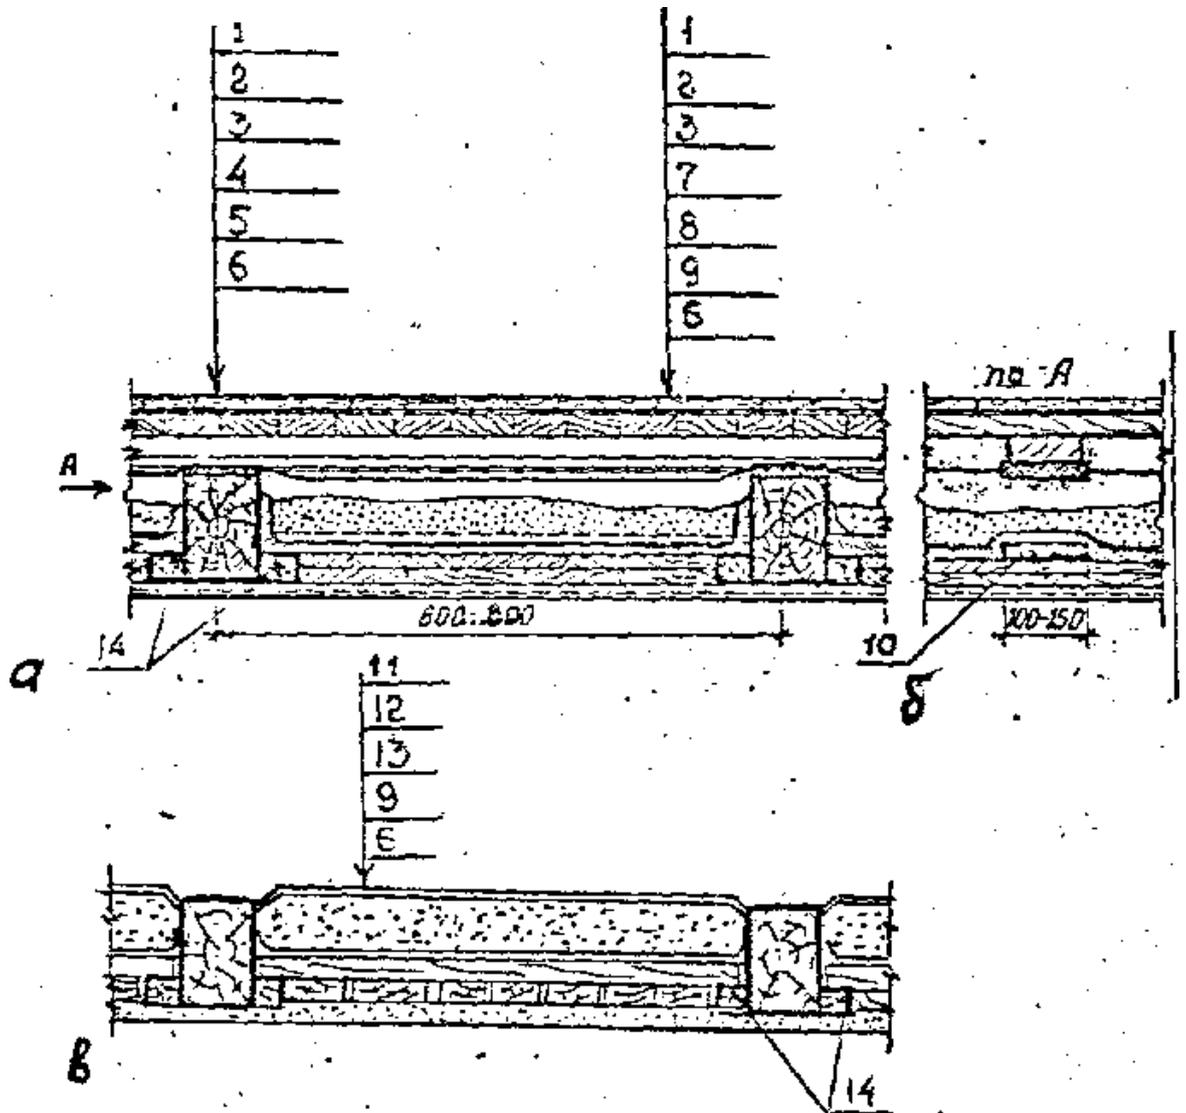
Приклад конструктивного вирішення перекриття по дерев'яних балках: а - міжповерхове перекриття; б - вид за "А"; в - горищне перекриття; 1 - паркет по будівельному паперу - 10; 2 - чорна підлога - 37; 3 - лага 100x60; 4 - пружна прокладка - мінеральна повсть 35; 5 - дерев'яна балка 120x240; 6 - тиньк - 25; 7 - засипка піском - 100; 8 - промазка глиною; 9 - щитовий накат - 70; 10 - опорна рейка щита; 11 - цементно-піщана стяжка - 15; 12 - засипка керамзитовим гравієм - 100; 13 - пароізоляція - один шар руберойду; 14 - черепні бруски 40x40 бруски 40x40
